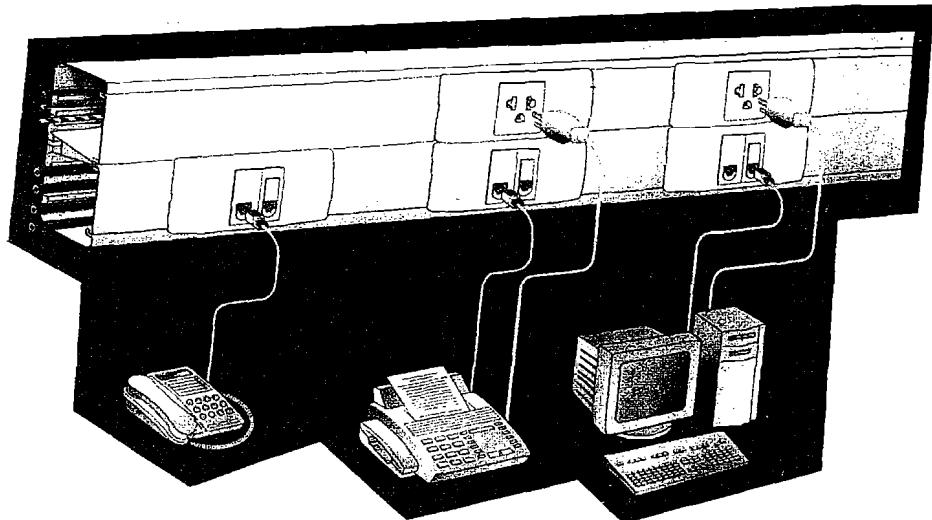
Canaleta DLP, solução para instalações aparentes. Fabricante Pial-Legrand
